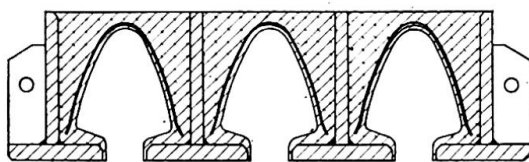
Querschnitt eines dreiteiligen Elementes.
